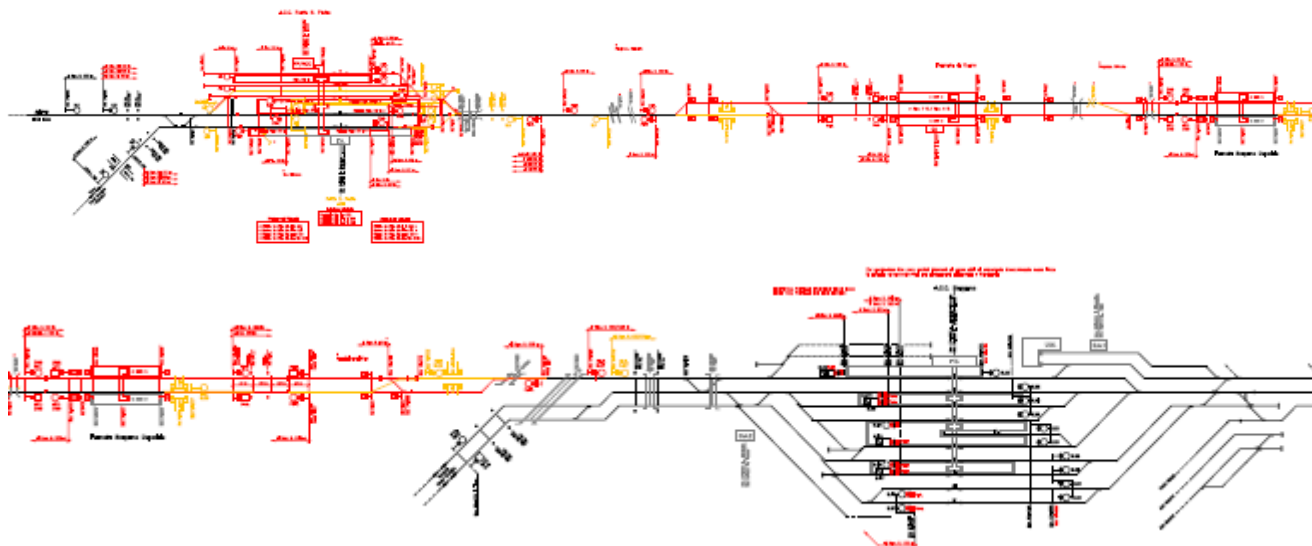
Piano schematico del lotto 1 del raddoppio Ponte S. Pietro – Montello
